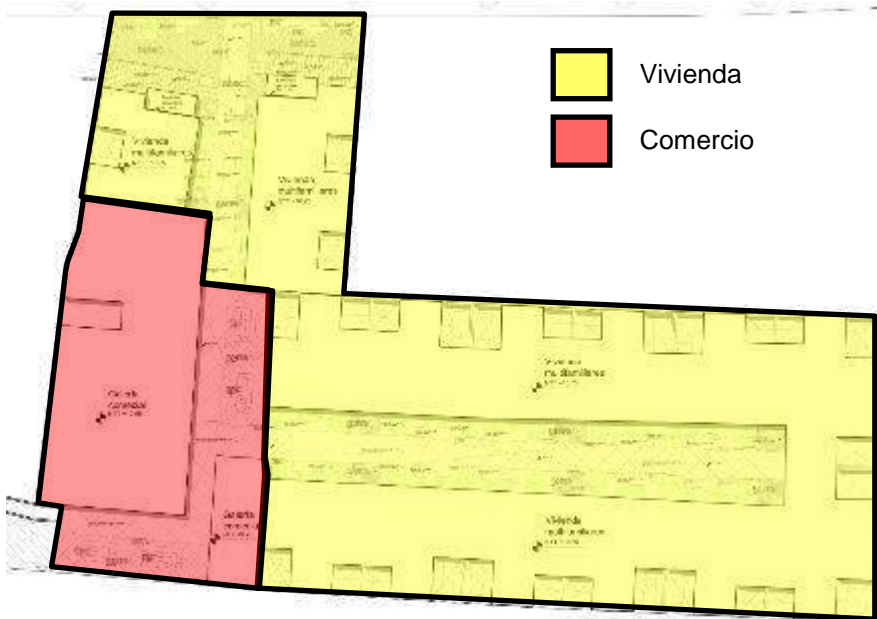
Vista en planta para identificar zona de vivienda y comercio
